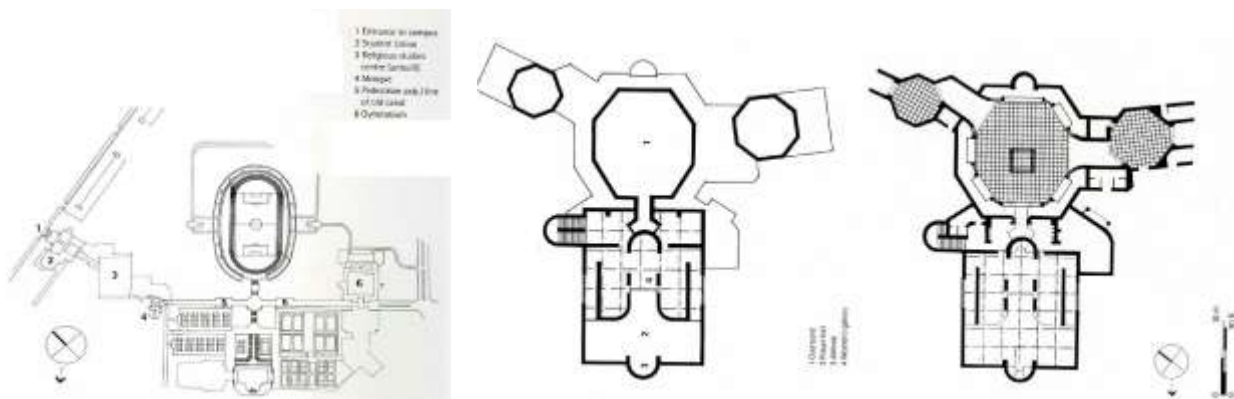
Planimetria del campus della Jondishapur University e planimetria della Moschea
